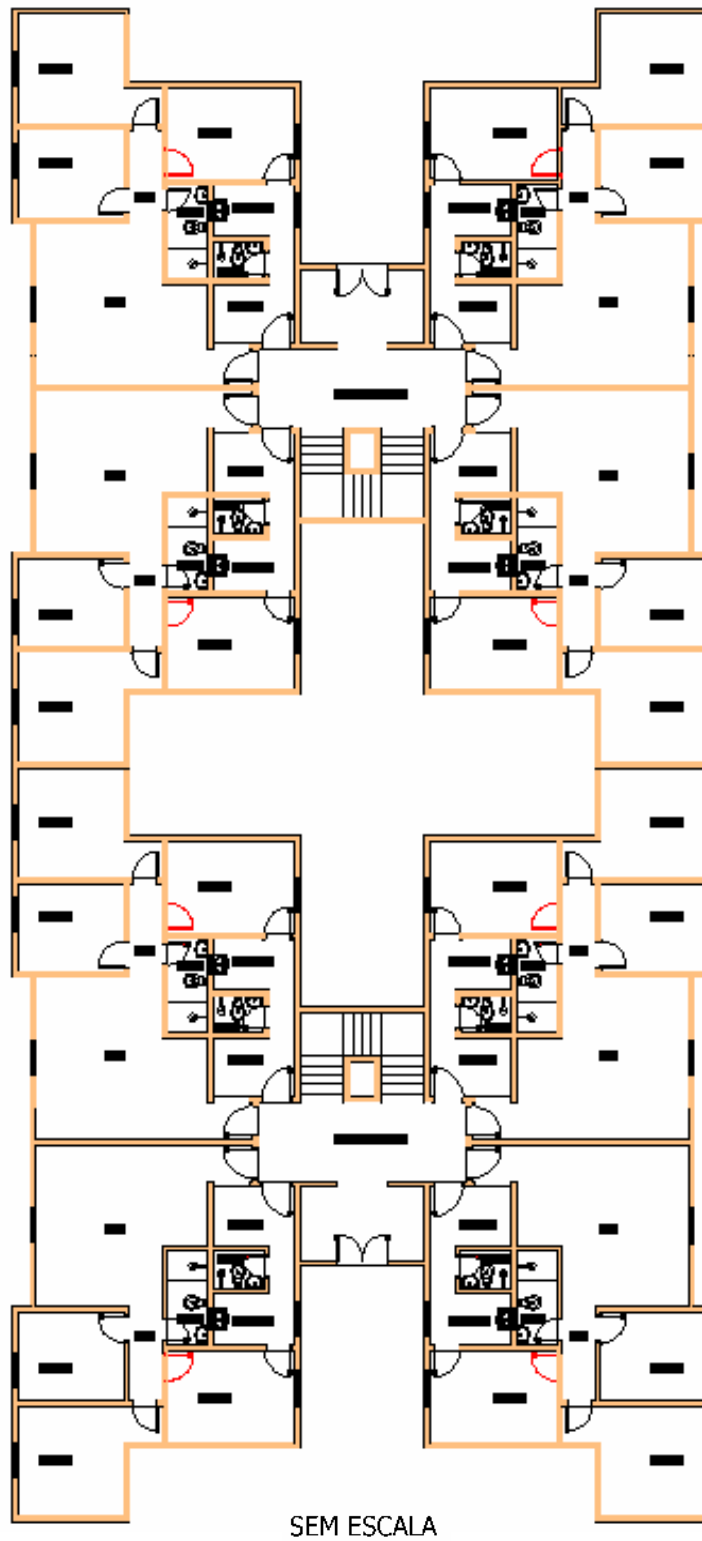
Planta Baixa ilustrativa do pavimento Tipo
